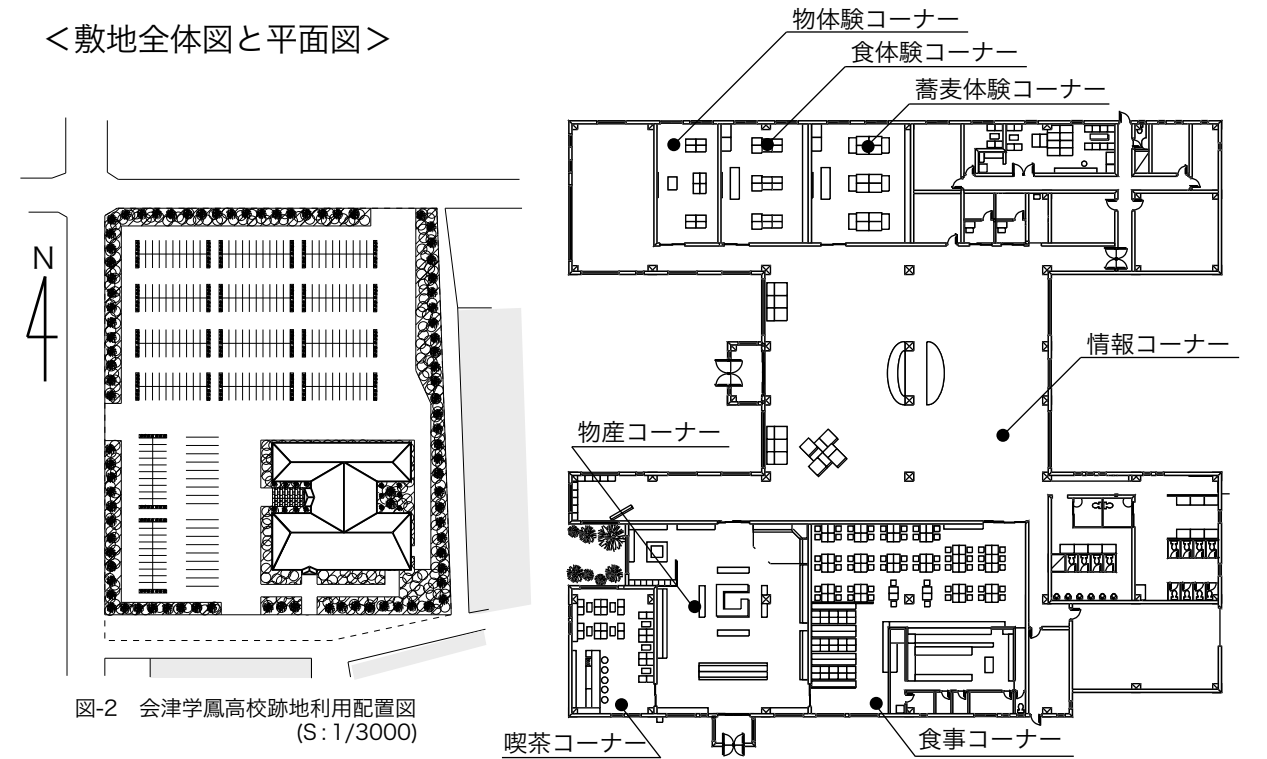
会津学鳳高校跡地利用配置図 (S: 1/3000)
